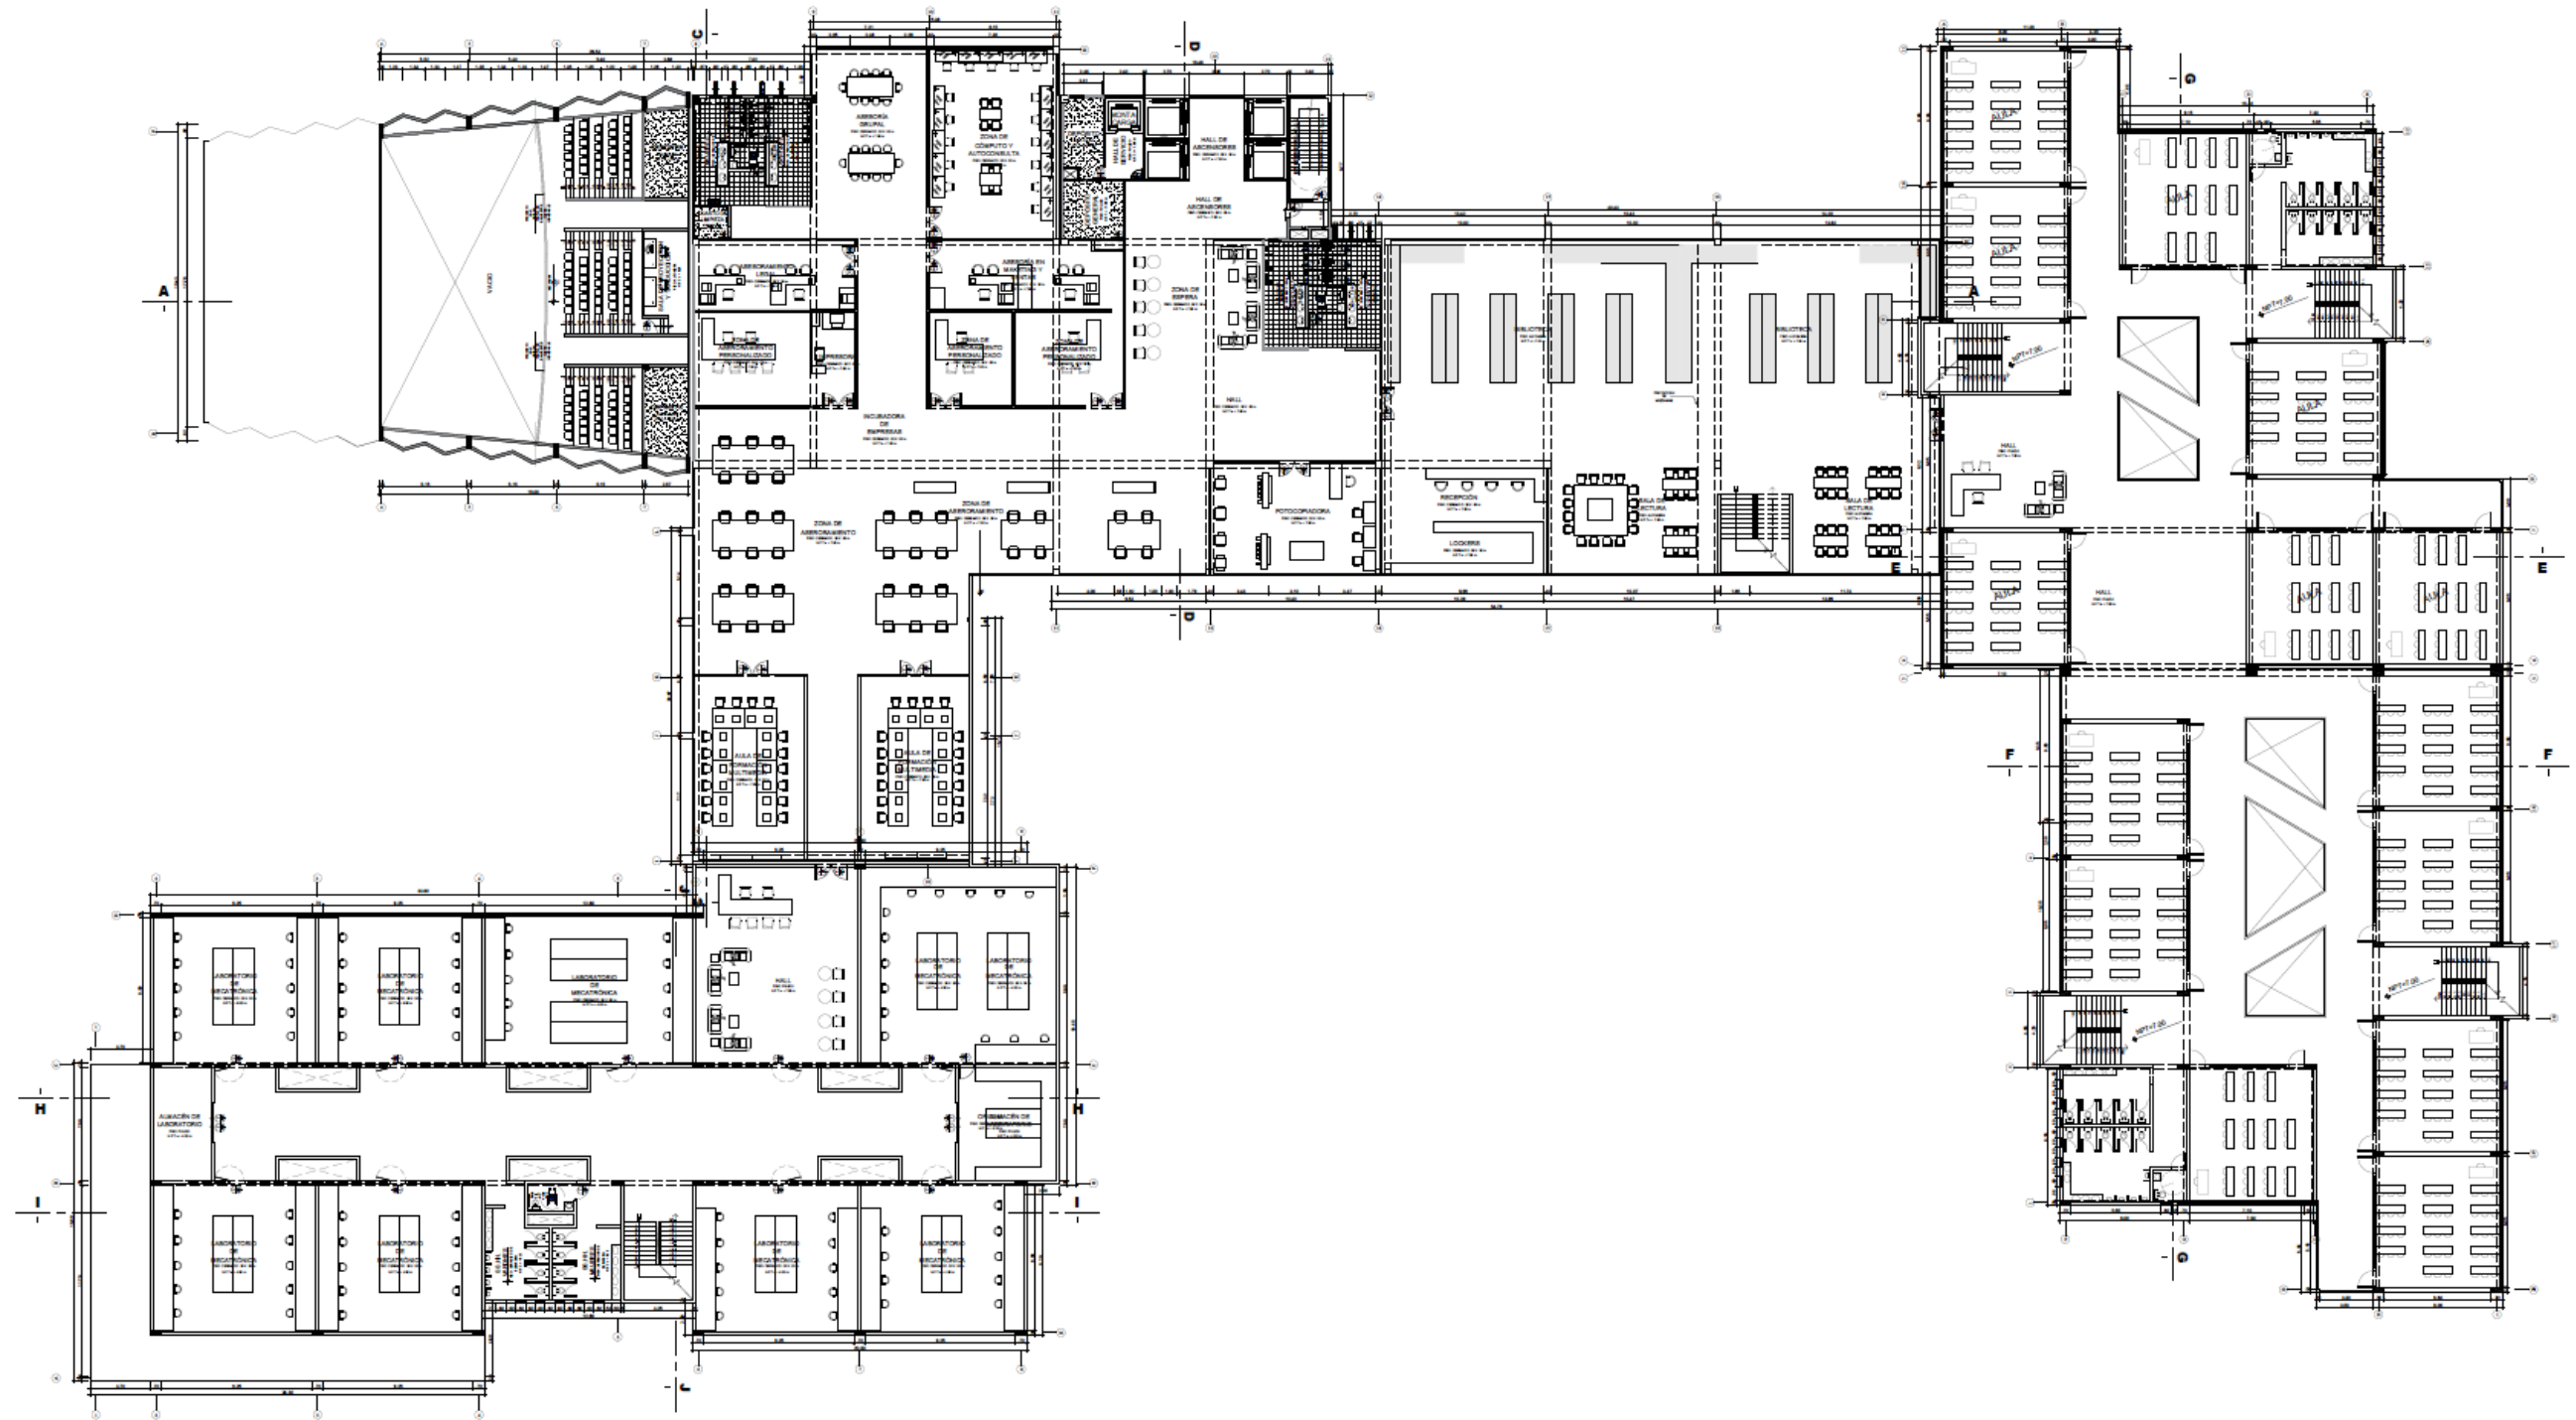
Plano Tercer Nivel del Proyecto. Elaboración Propia.
